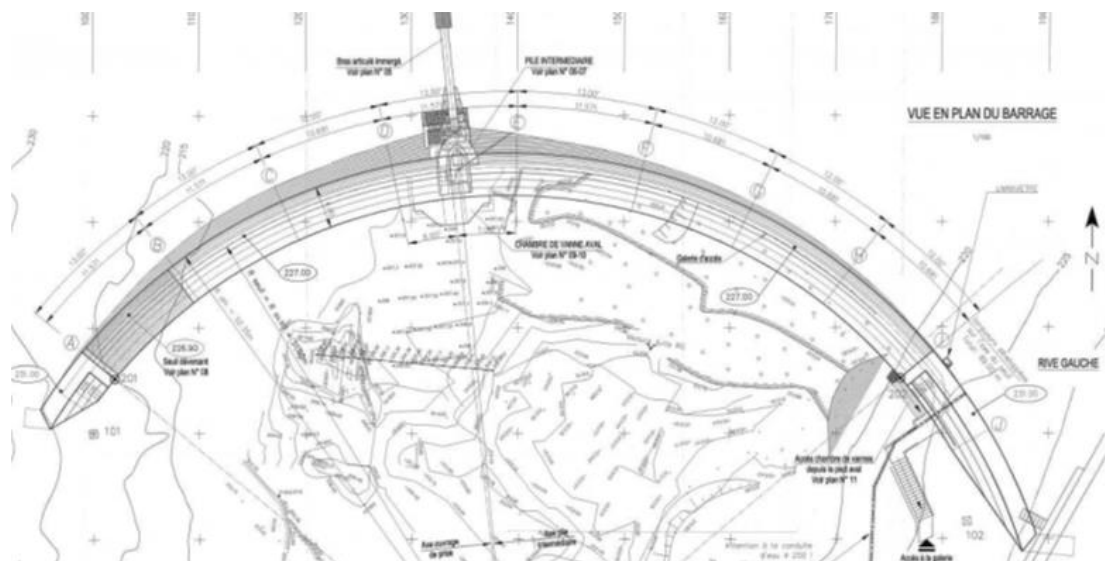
Vue en plan de l'ouvrage dans son ensemble
